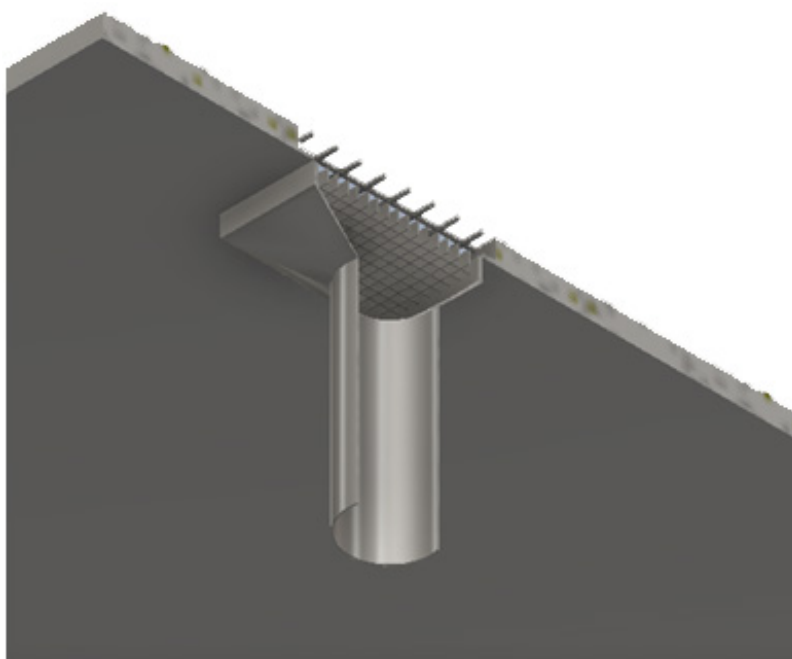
Sezione assonometrica dal basso bocchetta 40 cm x 40 cm.
